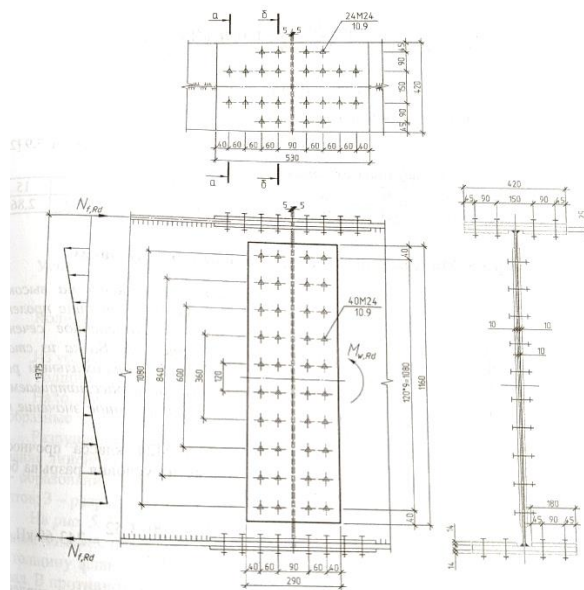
а) равнопрочный стык составной балки на сварке, б) конструкция узла балки на болтах
